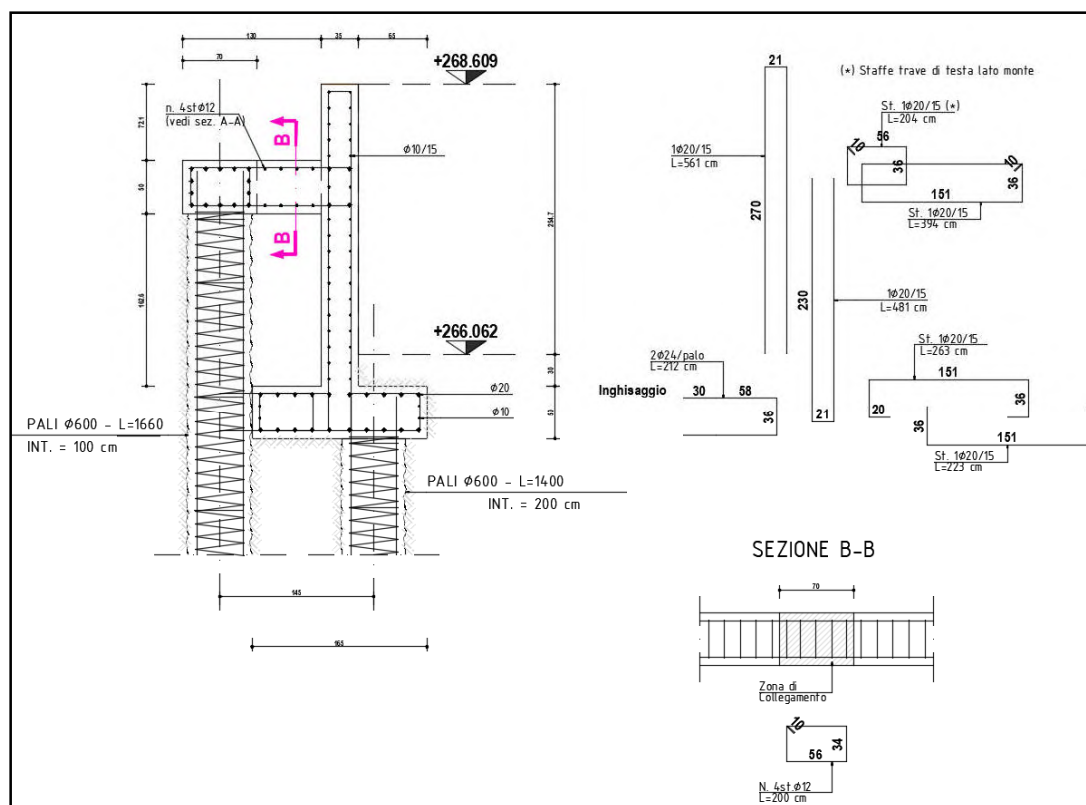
Sezione tipologica del muro di sostegno comprensiva di armatura.
